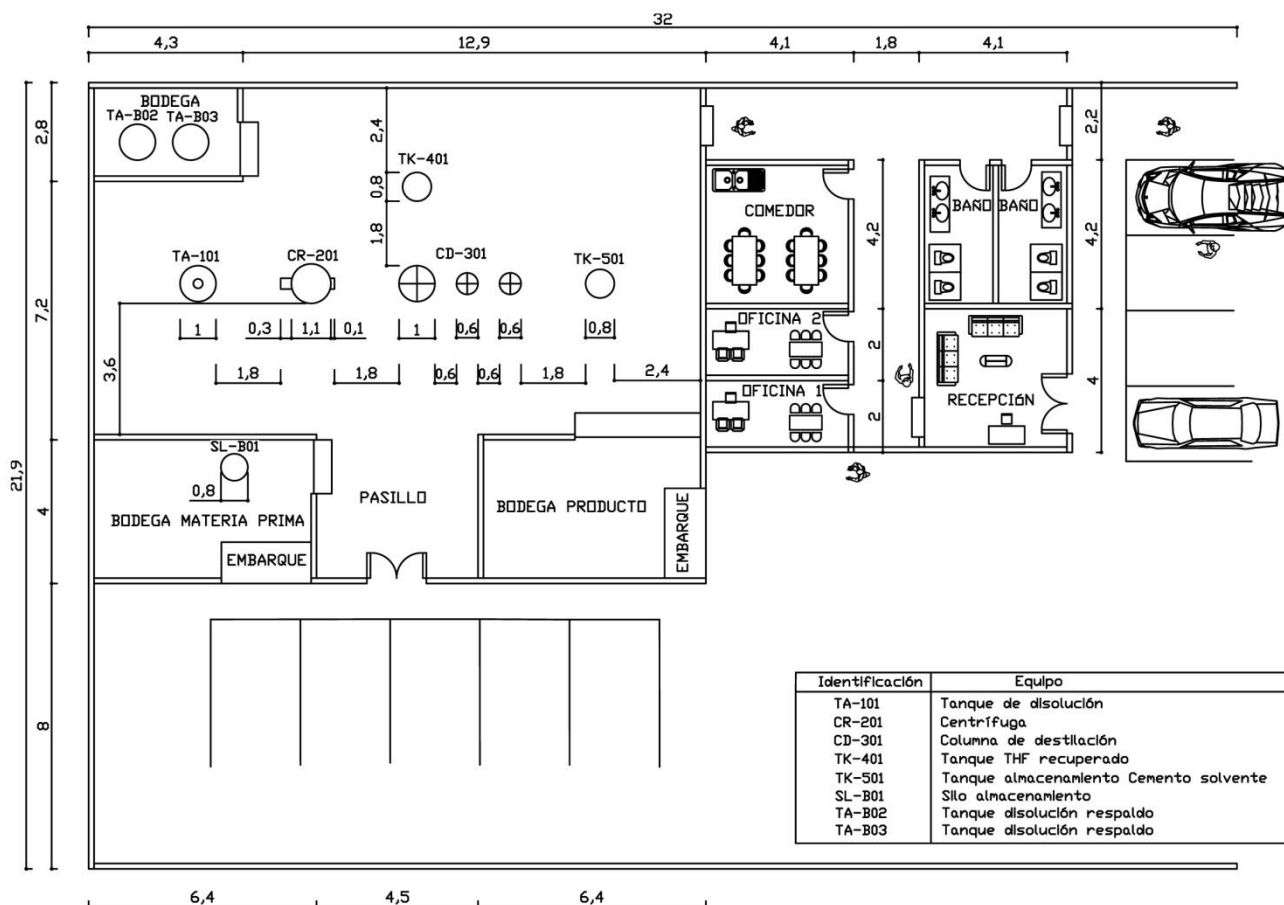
Plano de distribución de la planta piloto para la producción de cemento solvente de PVC
